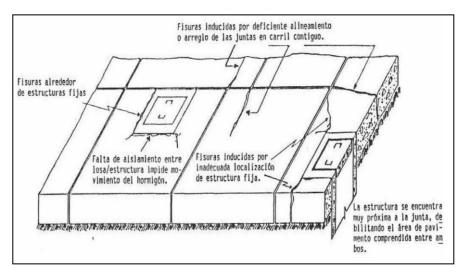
Falla por fisura Inducida de Pavimento Rígido
